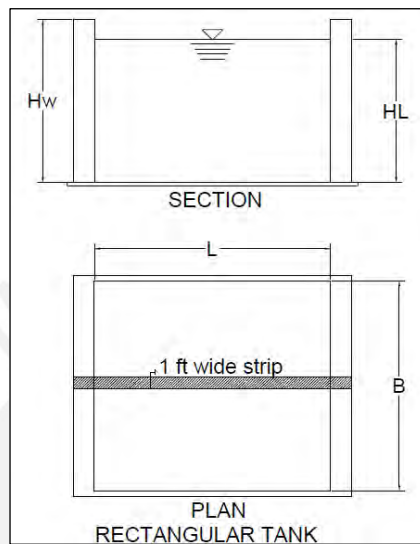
Vista en corte y planta de un reservorio (ACI 350-06, 2006)
